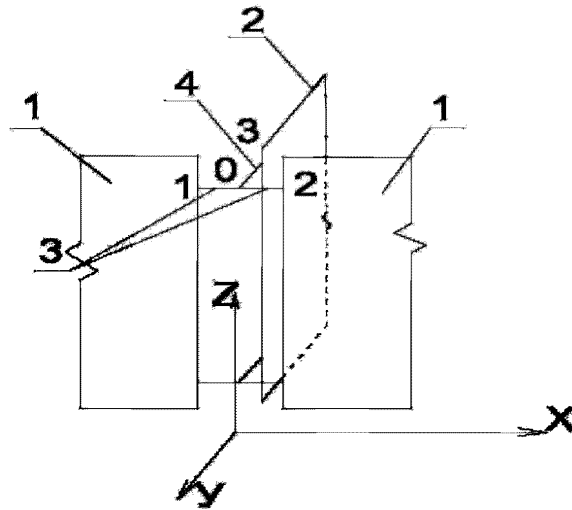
Схема расположения связей между стеновыми панелями в вертикальном стыке при соединении панелей на скобах с замоноличиванием стыка:
